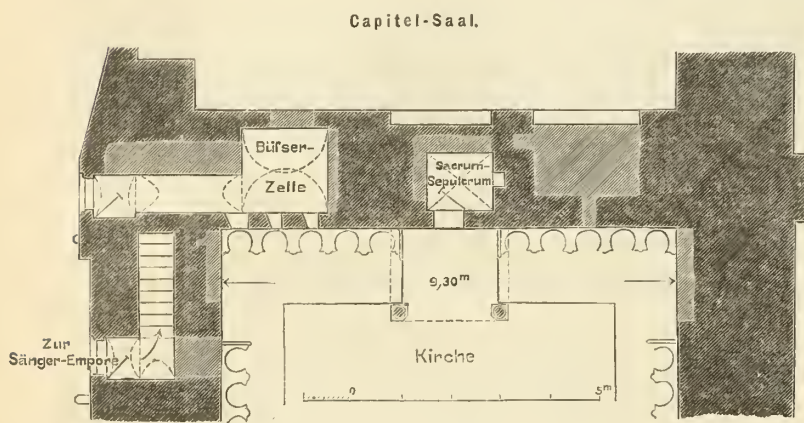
Westwand der Kirche. — Unterer Grundriss.
